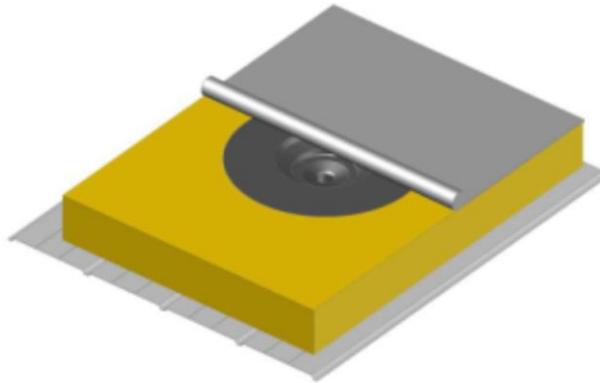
Soudage à l'air chaud de la membrane PVC sur la platine recouverte de PVC-P
